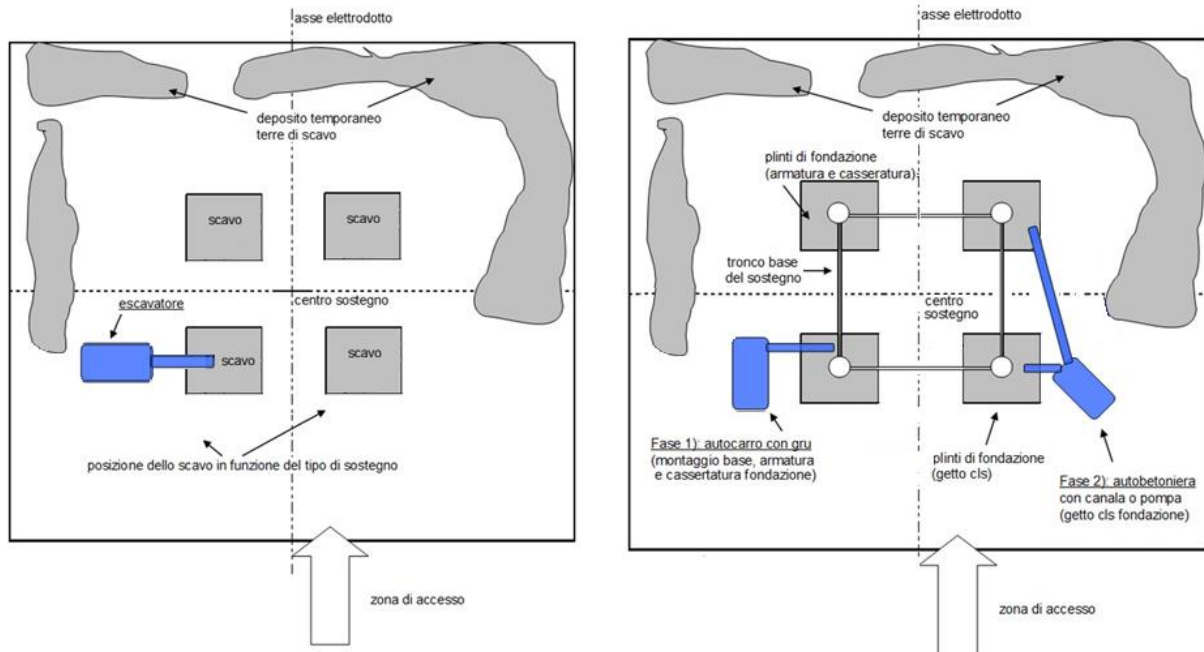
Planimetria dell'area di sostegno (scavo di fondazione – getto e basi) -Tipologico
